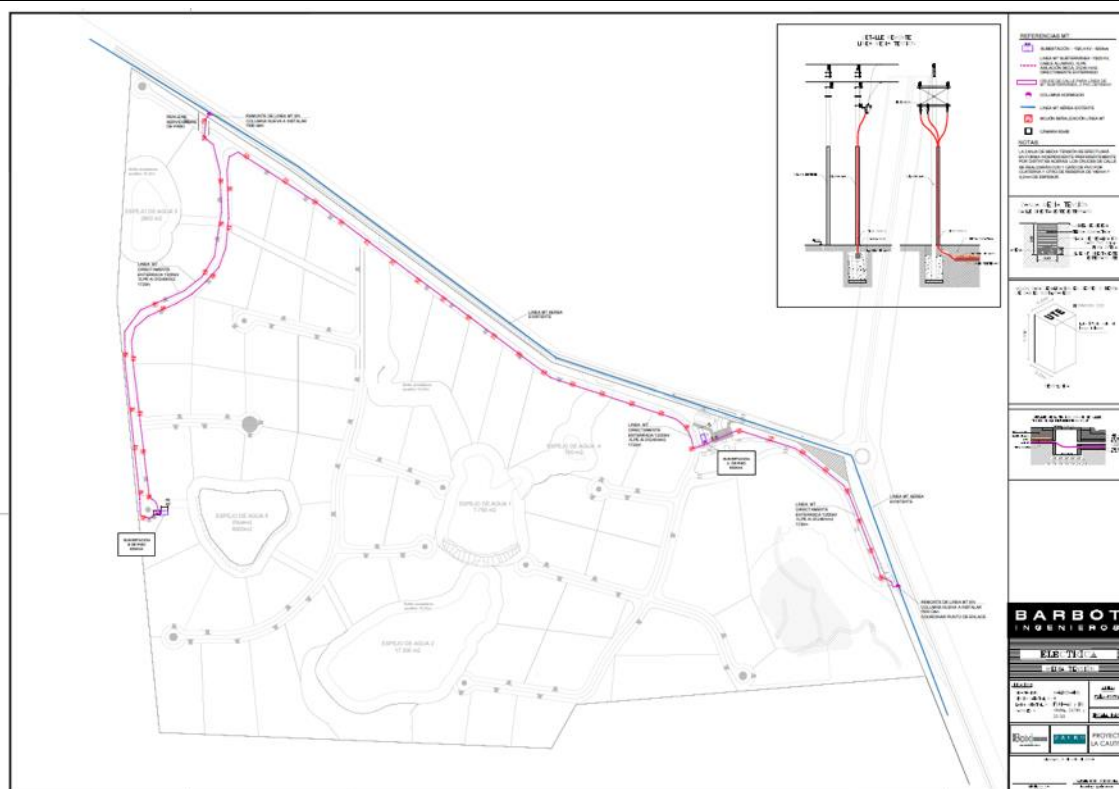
Plano infraestructura eléctrica, Media Tensión.
